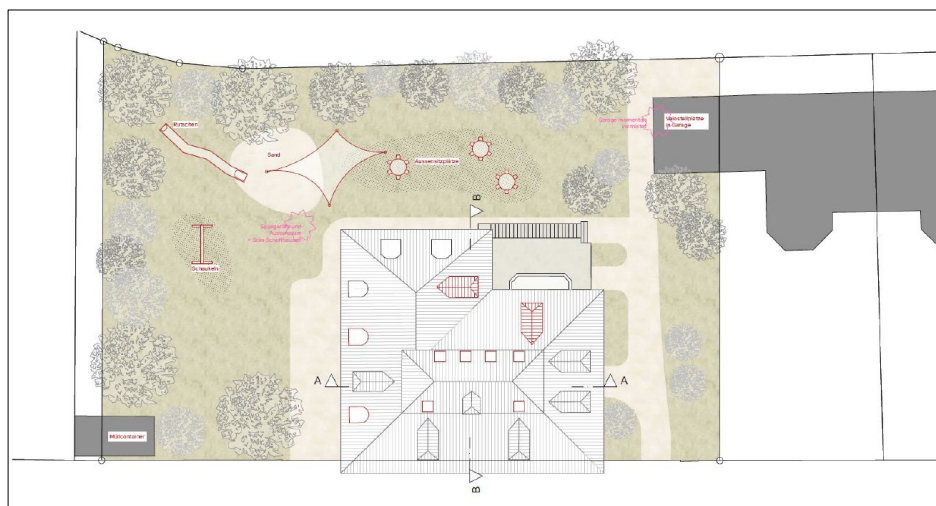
Visualisierung Dachgeschoss (Machbarkeitsstudie)
